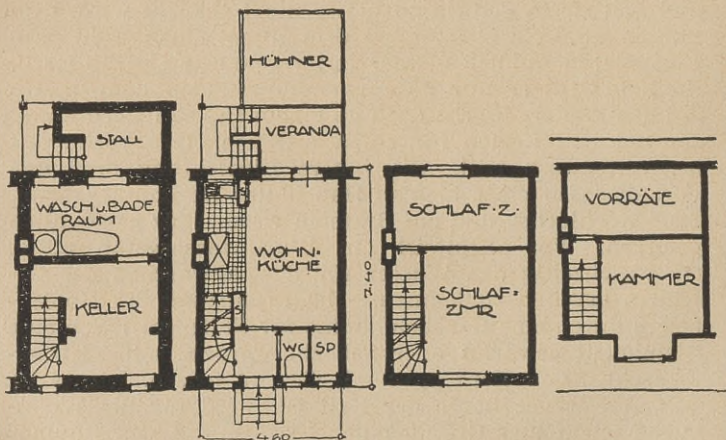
115. Kleines Reihenhaus mit Wohnküche als einzigem Raum im Erdgeschoß (Badischer Landeswohnungsverein)
